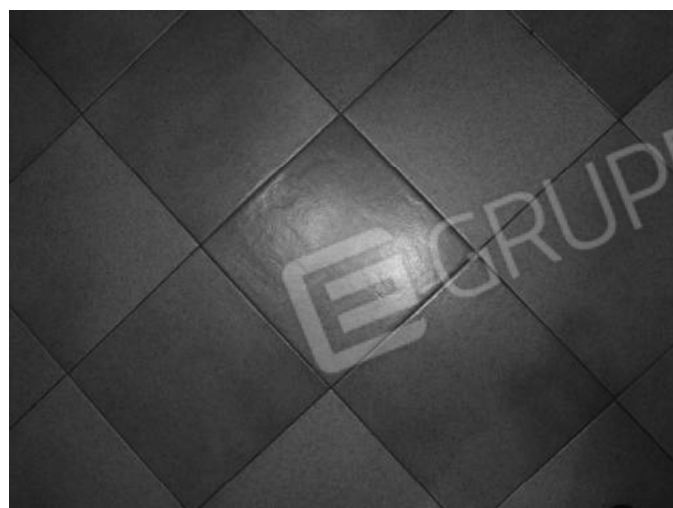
Particolare pavimentazione dell'ambiente Pranzo - cucina.
